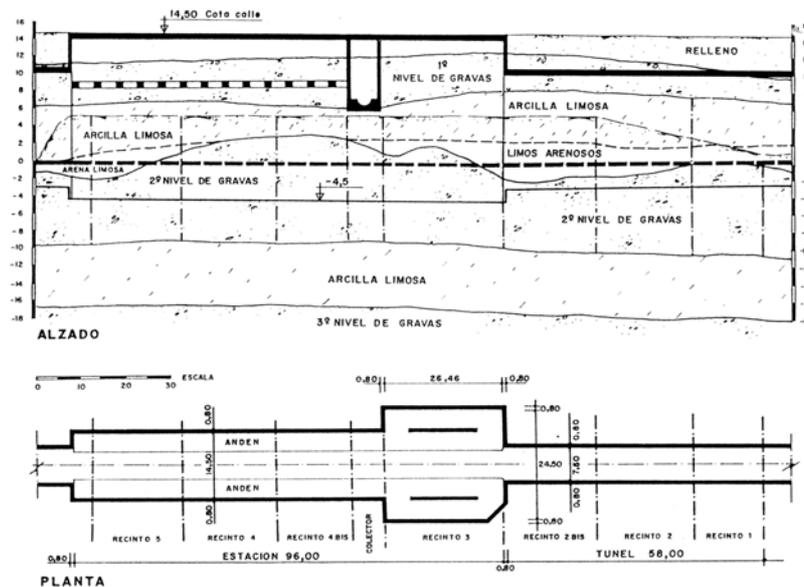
Planta y perfil longitudinal de la Estación y del túnel
